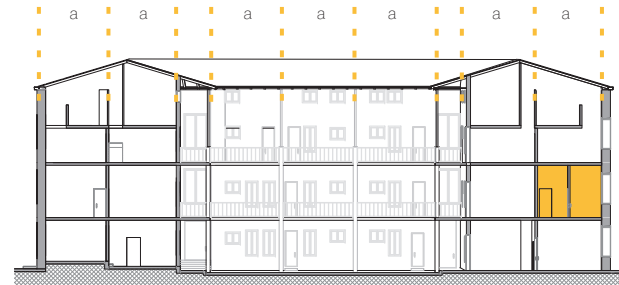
Sección transversal - Estructura y materiales_ Módulo
